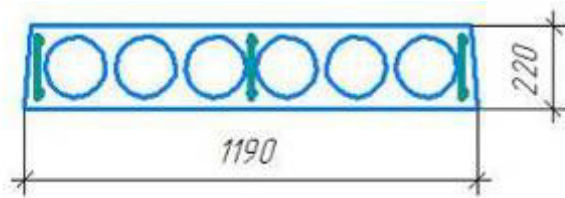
Поперечний переріз багатопорожнистої плити перекриття
